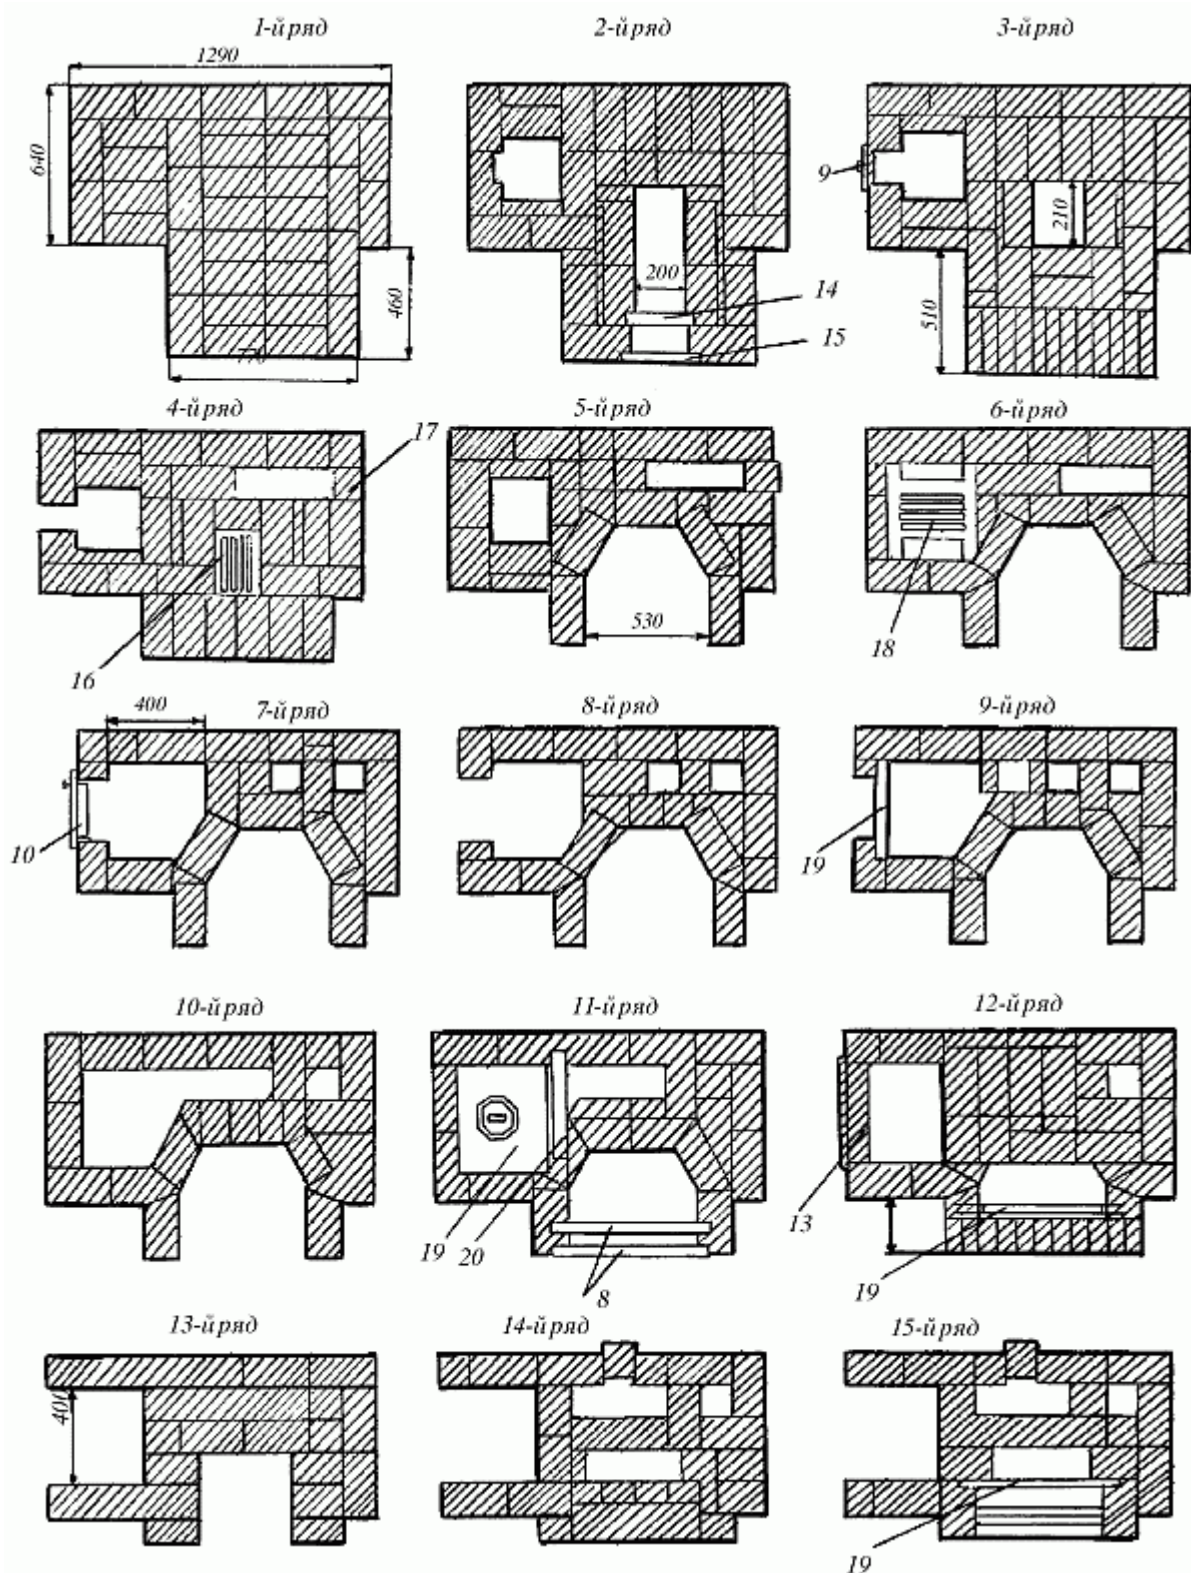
(продолжение). Последовательность кладки: 1 – доска каминная; 8 – уголок стальной; 9 – дверка поддувальная; 10 – дверка топочная; 13 – рамка из стальных уголков; 14 – уголок стальной; 15 – полоса стальная; 16 – решетка колосниковая; 17 – кирпичи-вкладыши прочистные (дверки прочистные 140 x 140 мм); 18 – решетка колосниковая для топки; 19 – уголки стальные; 20 – плита чугуная с одной конфоркой
